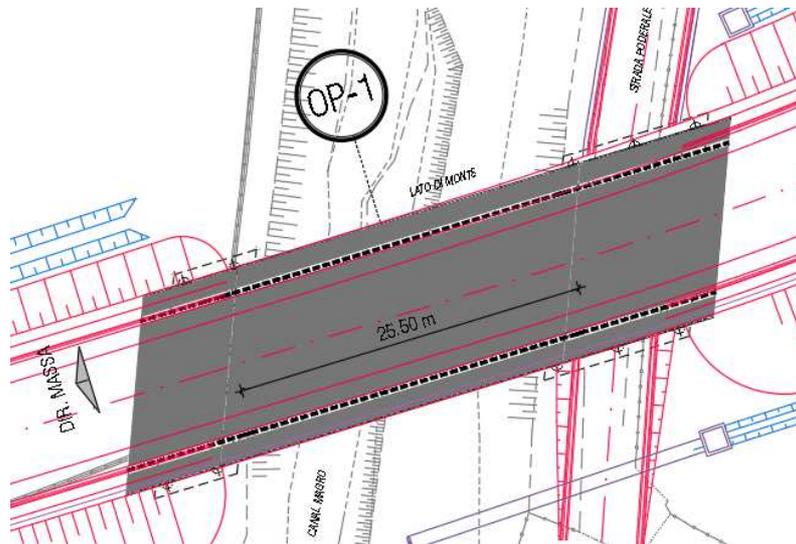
Ponte sul canal magro – estratto planimetria di inquadramento
